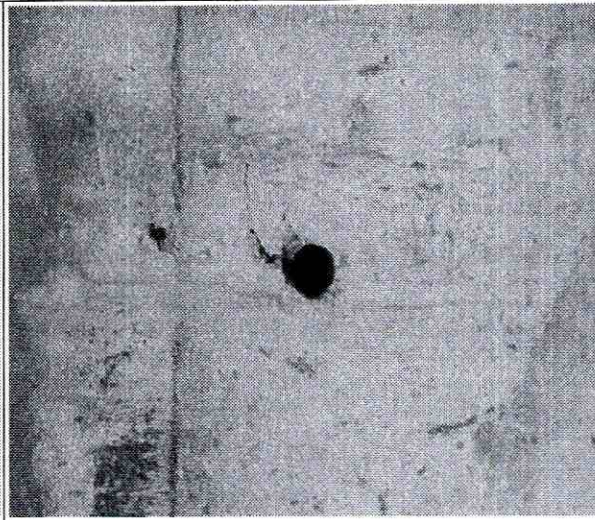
Lloraderos en contrapendiente, muro costado norte
